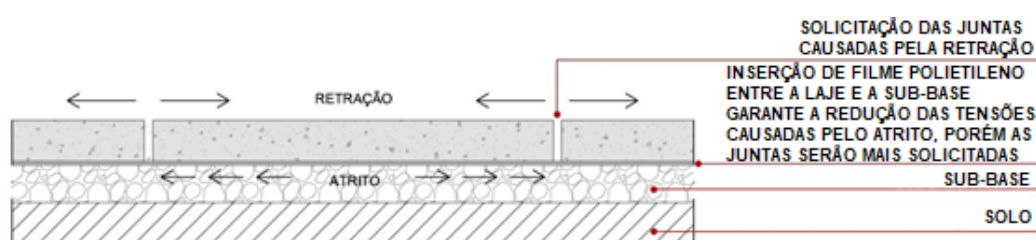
Retração do betão [adaptado de Cristelli (2010)]
